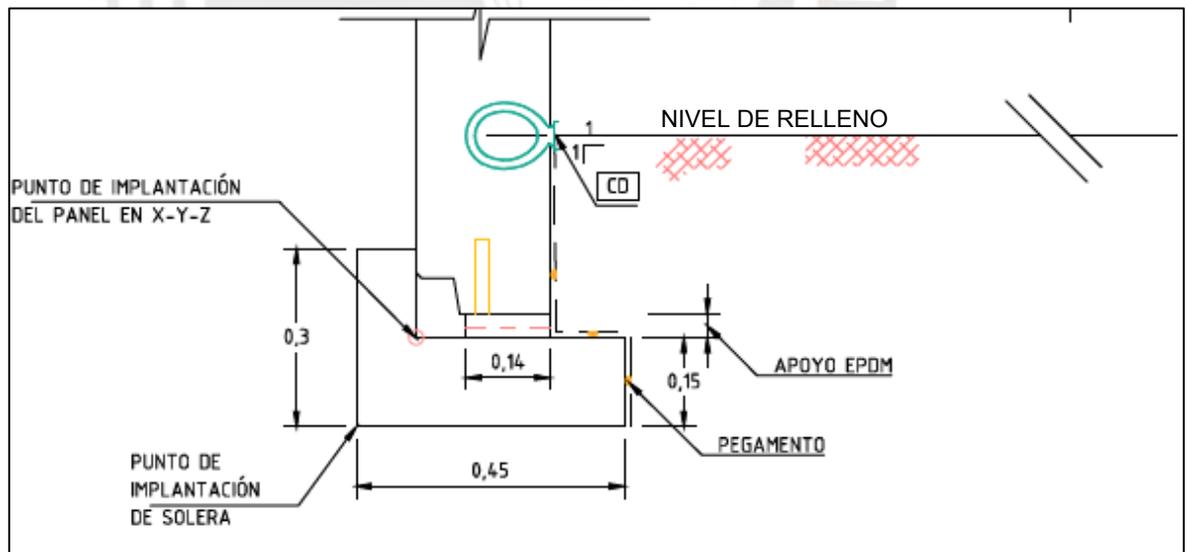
7 Nivel de relleno hasta alcanzar los conectores del panel prefabricado. Fuente: (Freyssinet Tierra Armada, 2015)
